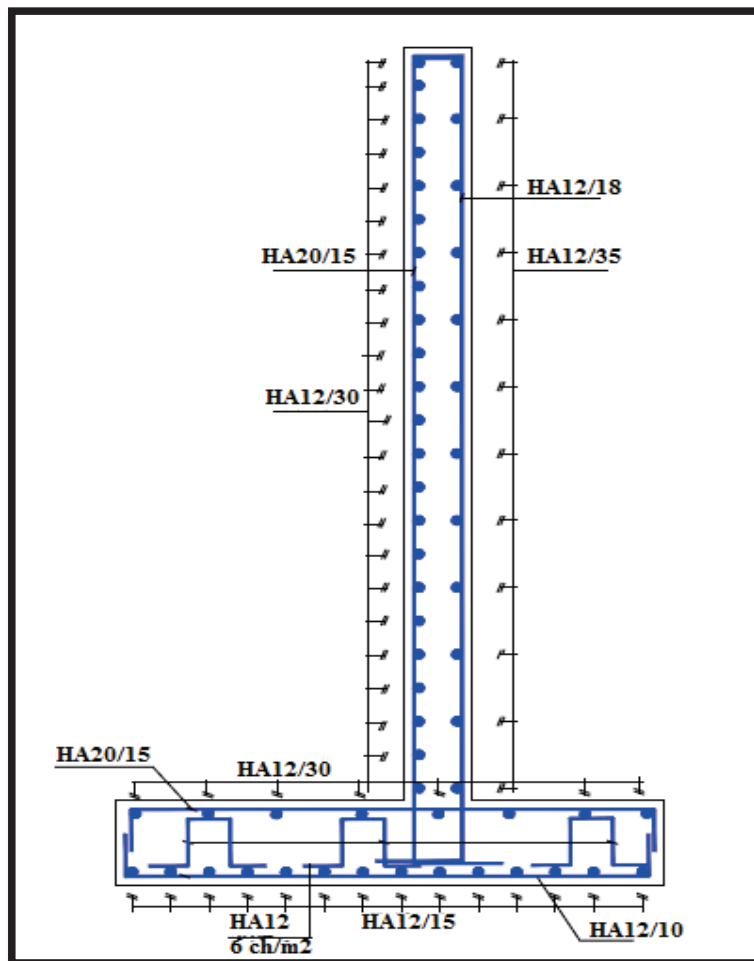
ferrailage du mur de soutènement (H=5 m)
